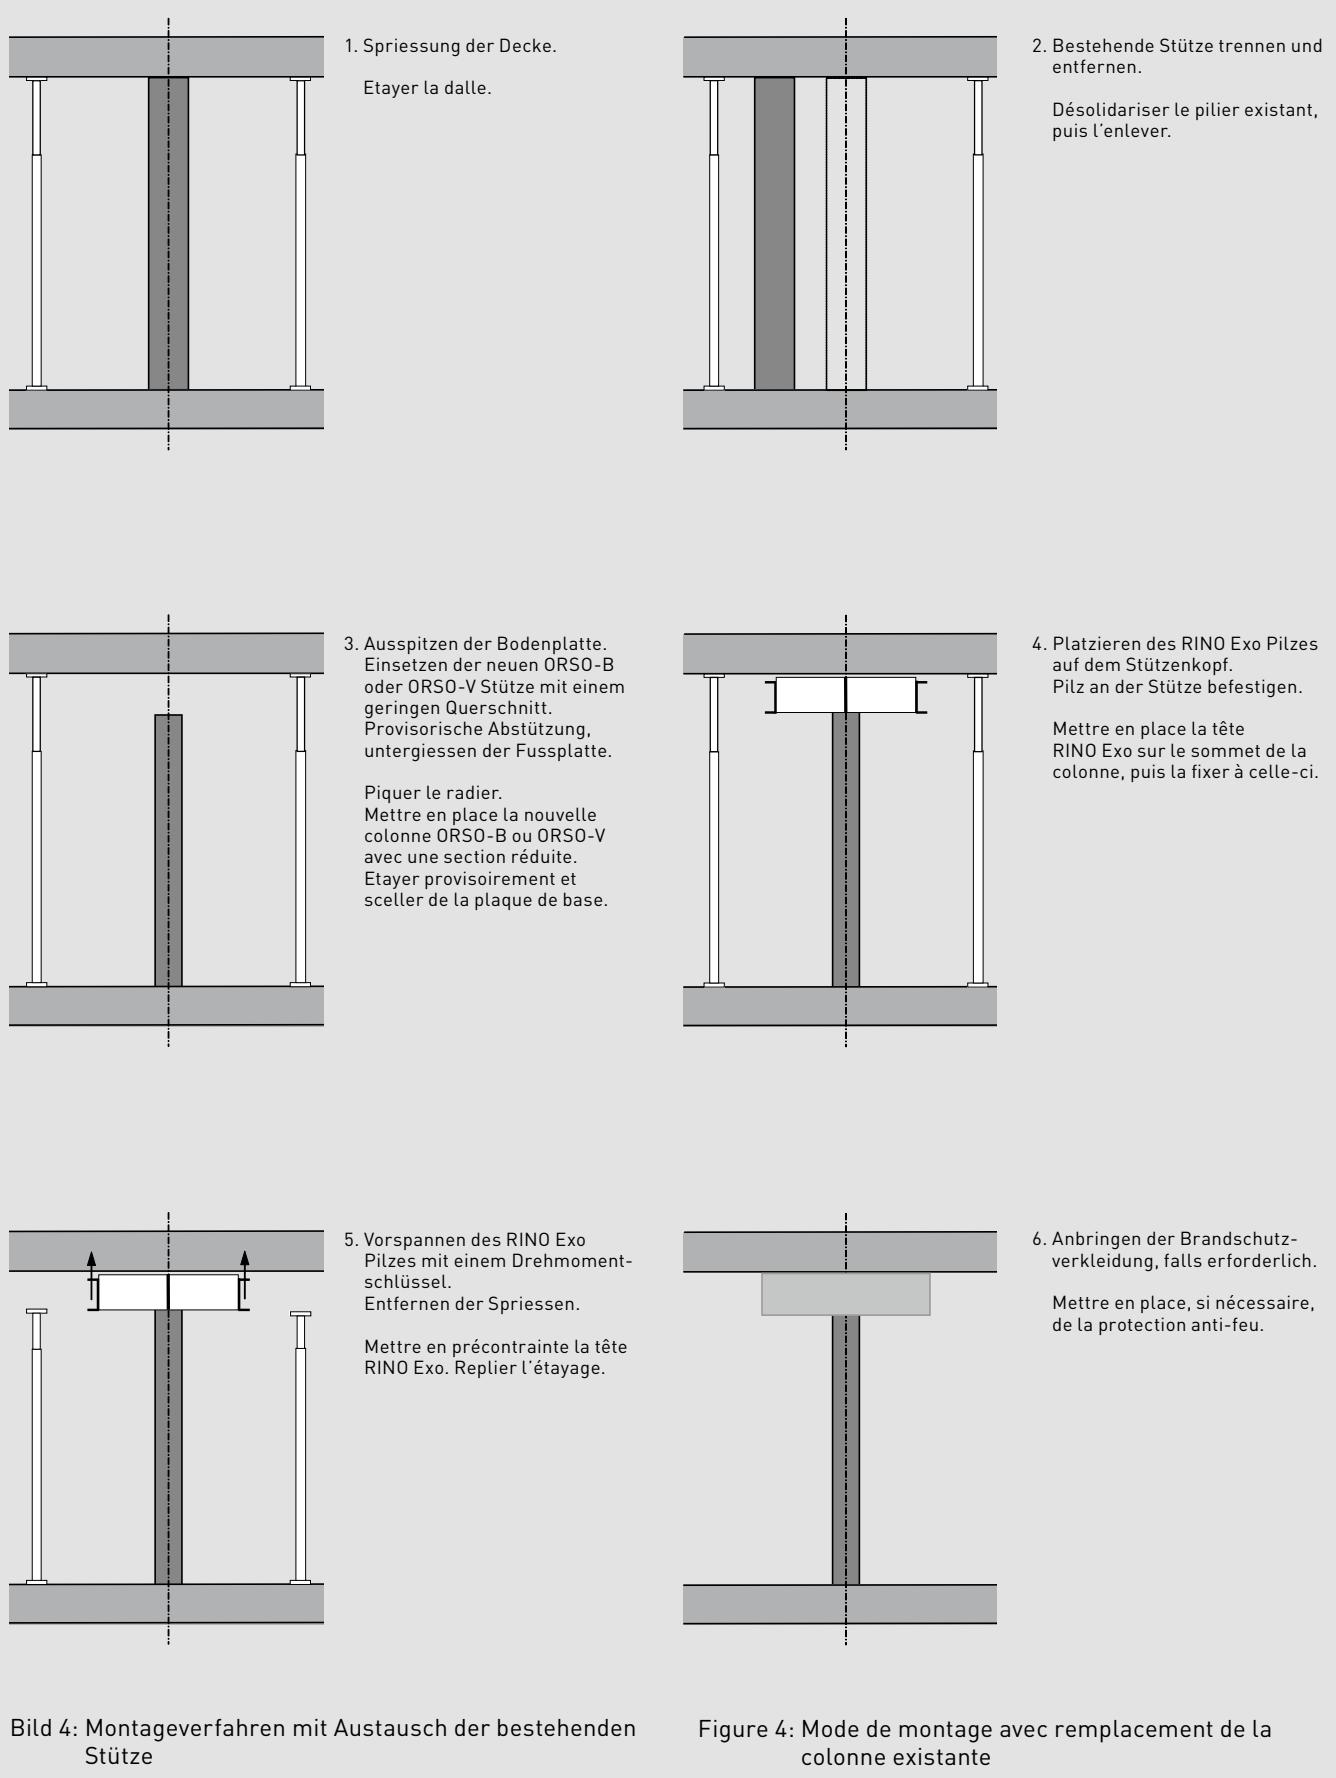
Montageverfahren mit Austausch der bestehenden Stütze
